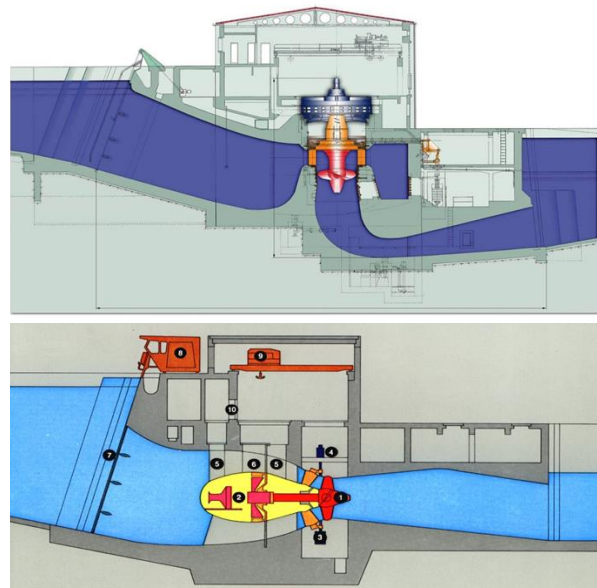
Vertikalachsige Kaplan turbine, Schnitt Typische Bauweise der 60er Jahre für Laufkraftwerke an grösseren Mittellandflüssen (oben). Horizontalachsige Rohr-Kaplan turbine, typische Bauweise neuer Laufkraftwerke an grösseren Mittellandflüssen (unten, Zeichnungen: Andritz Hydro AG).
